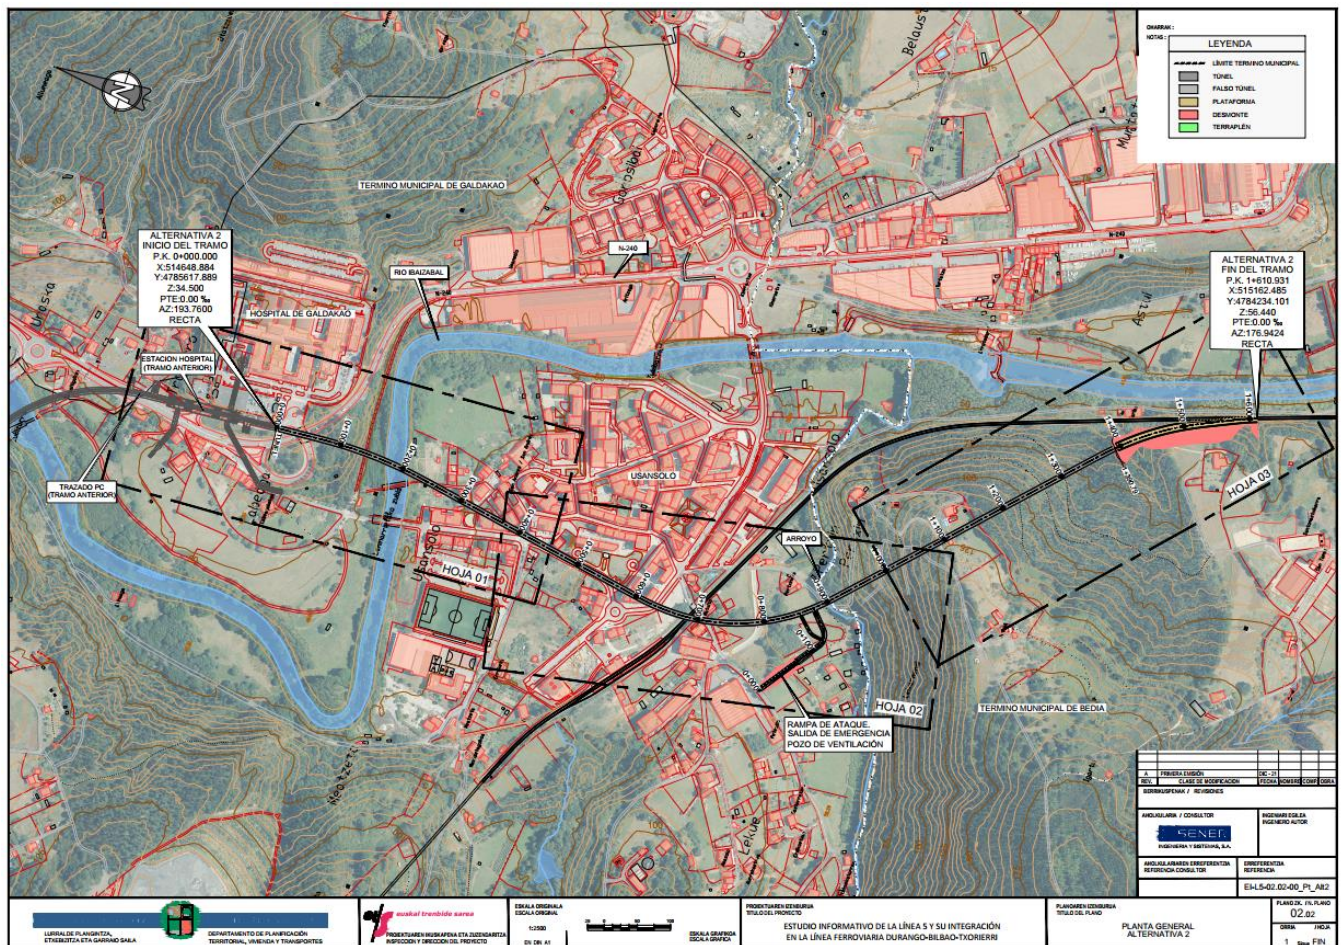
Planta del tramo incluido en el alcance - Alternativa 2.
